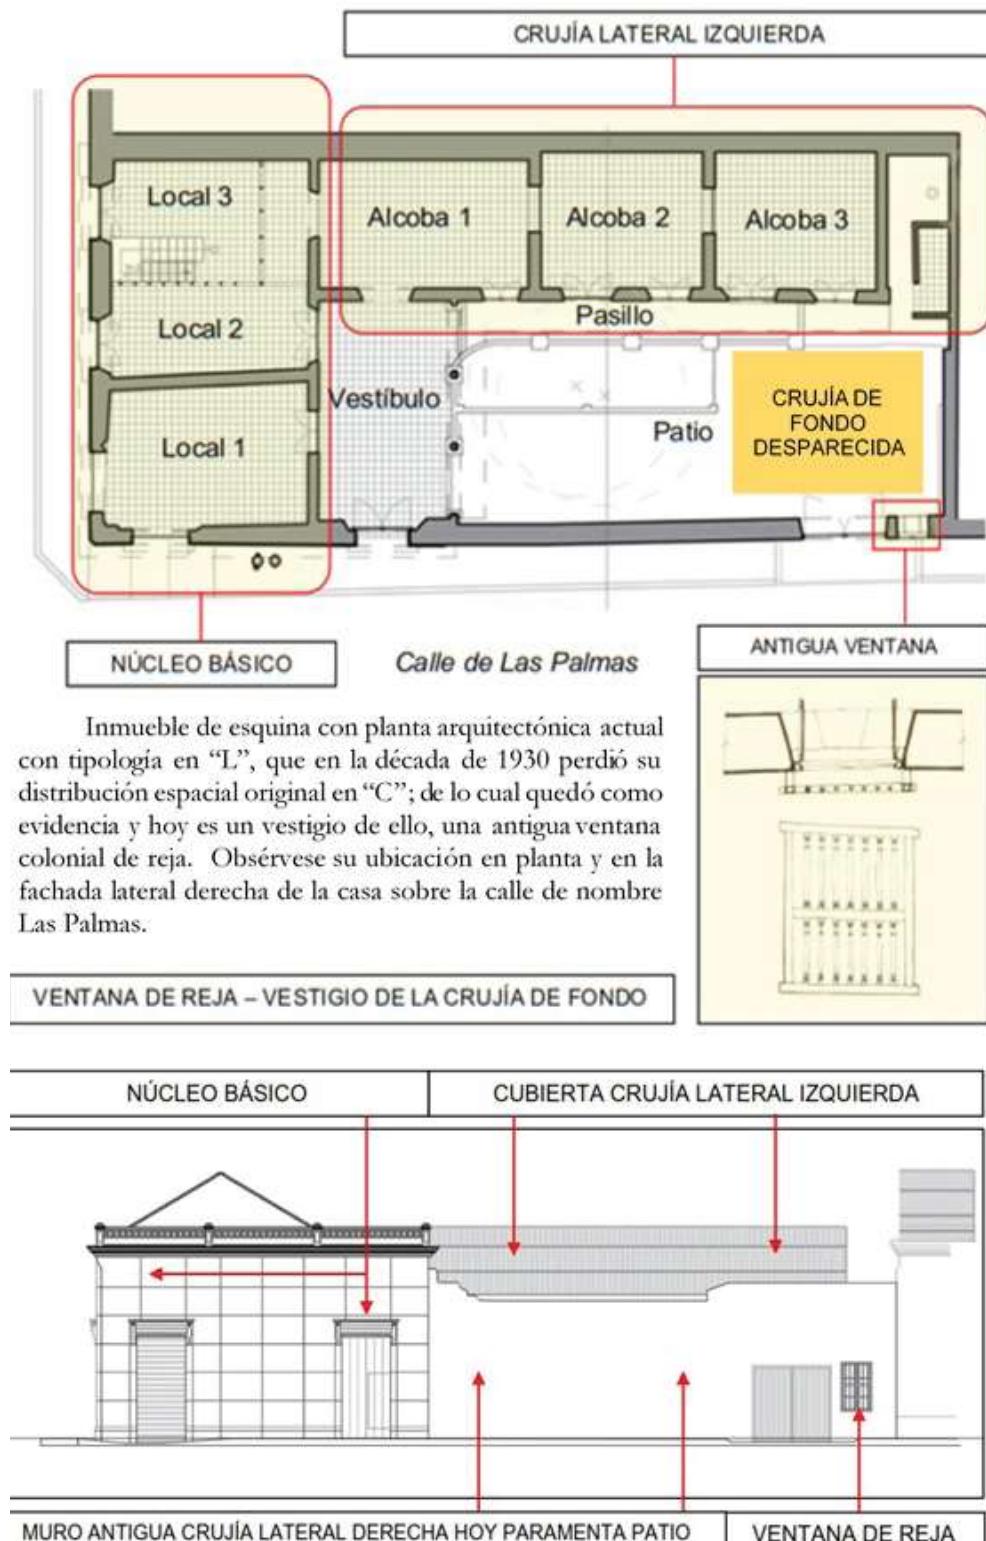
Planta Arquitectónica general y Fachada Lateral casa “Landinez”. Fuente: Levantamiento arquitectónico elaboración propia y Andrés Felipe Mendoza.
